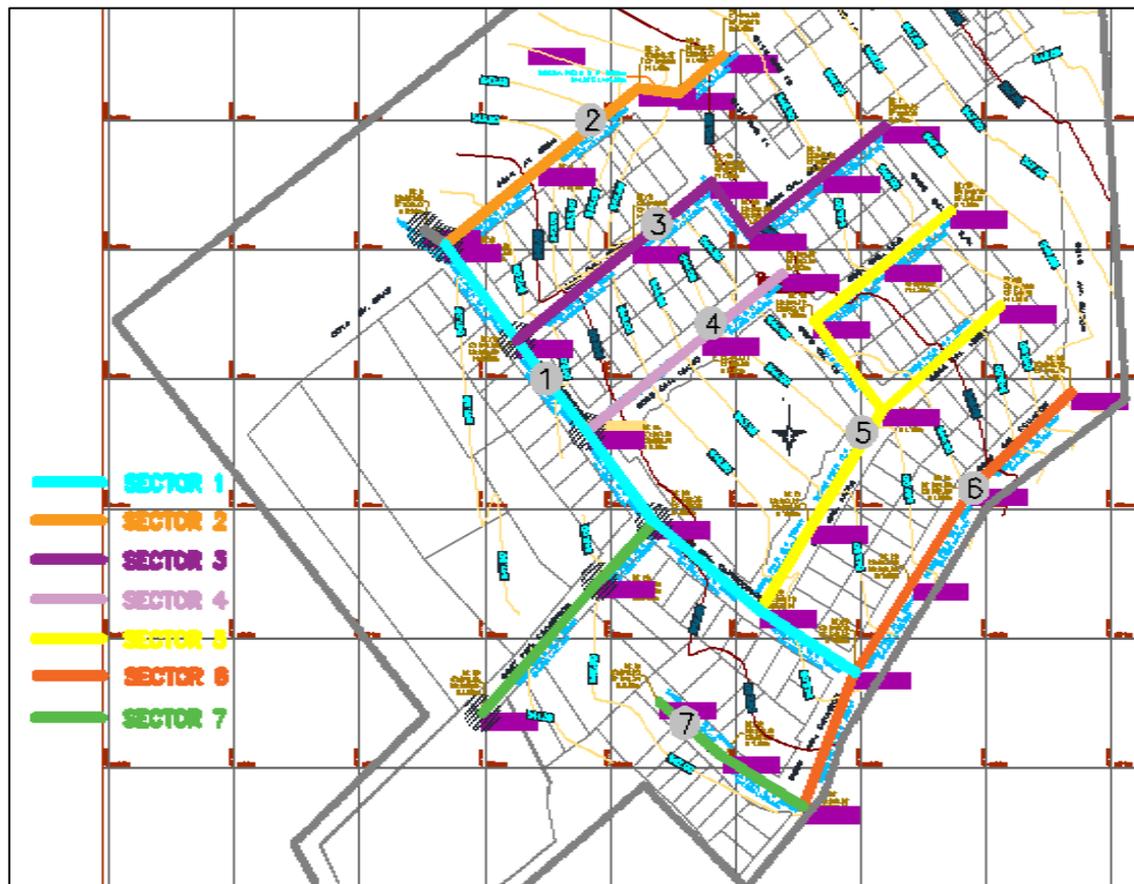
Sectorización del sistema de alcantarillado - Obra 2
